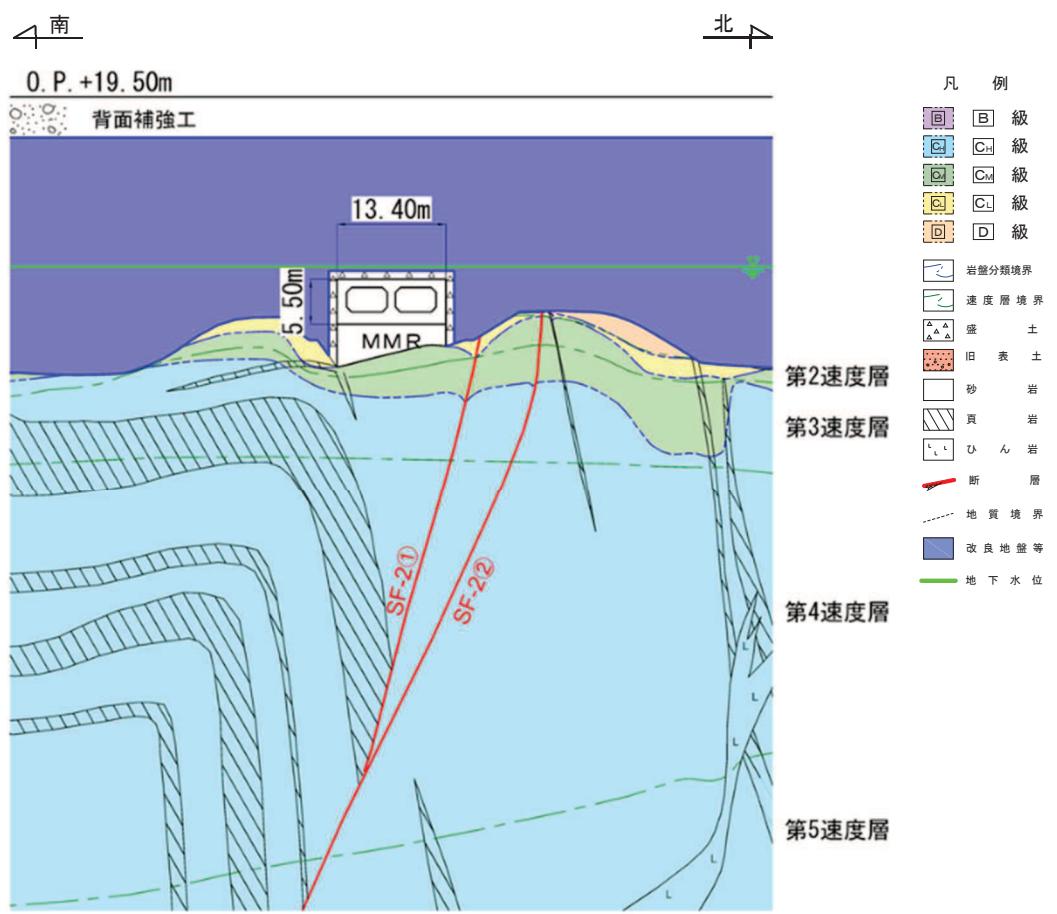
取水路（標準部）地質断面図（断面⑤：曲線部）
